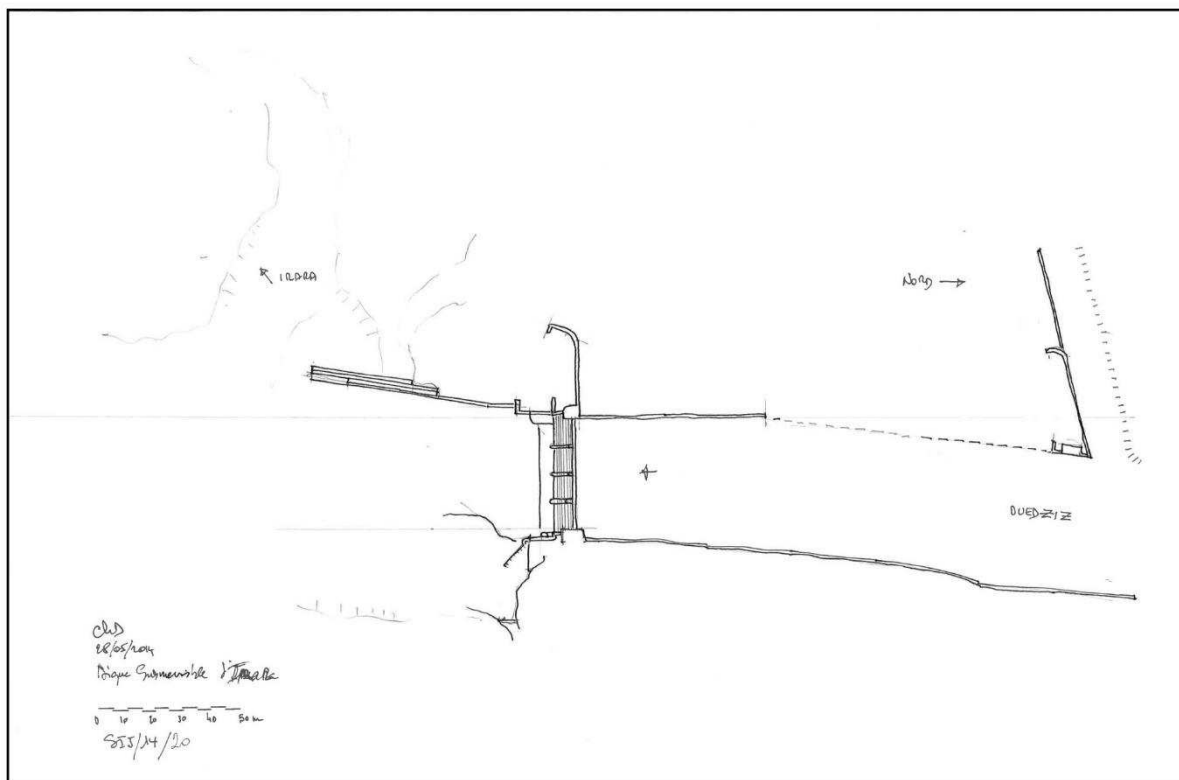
Coupe et plan du barrage d'Irara. Dessins : Ch. Darles, 2014.
